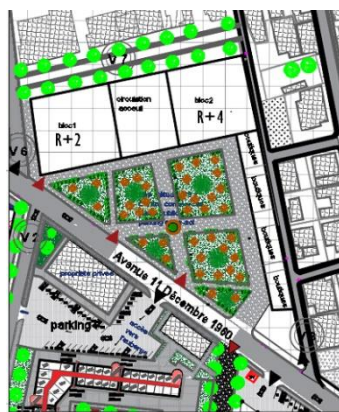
Plan de masse / Source : traiter par l'auteur.
